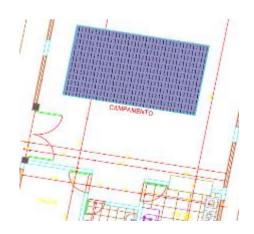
Levantamiento de planos en AutoCAD área conjunta a los baños y ubicación de campamentos, susagua.
